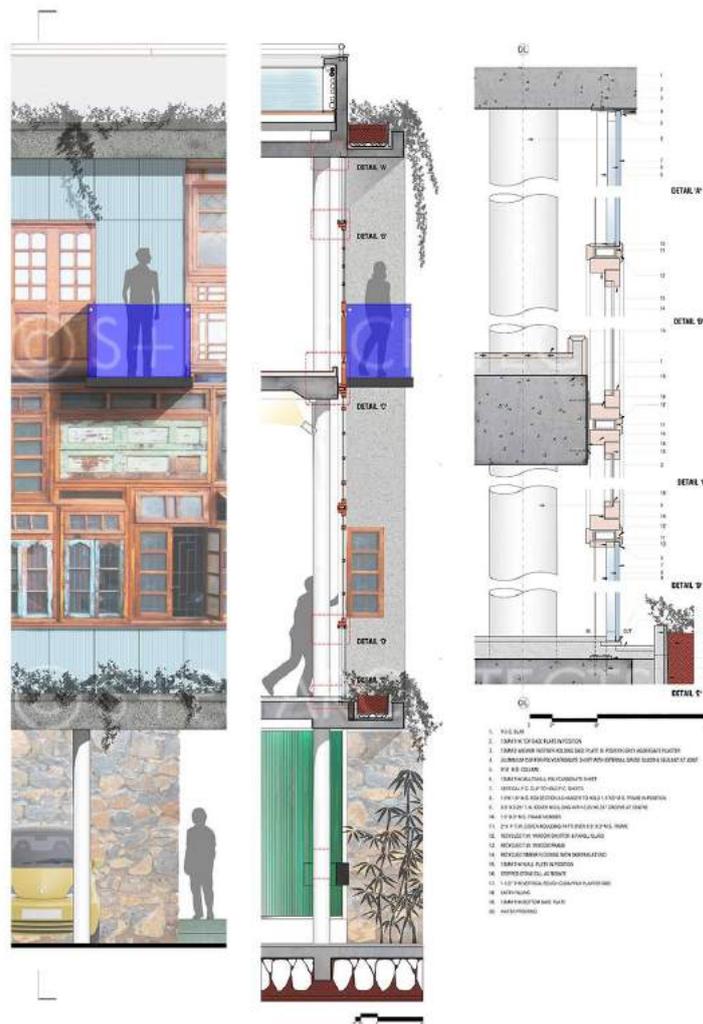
Pormenor fachada Principal Collage house (S+PS Architects, 2015)
